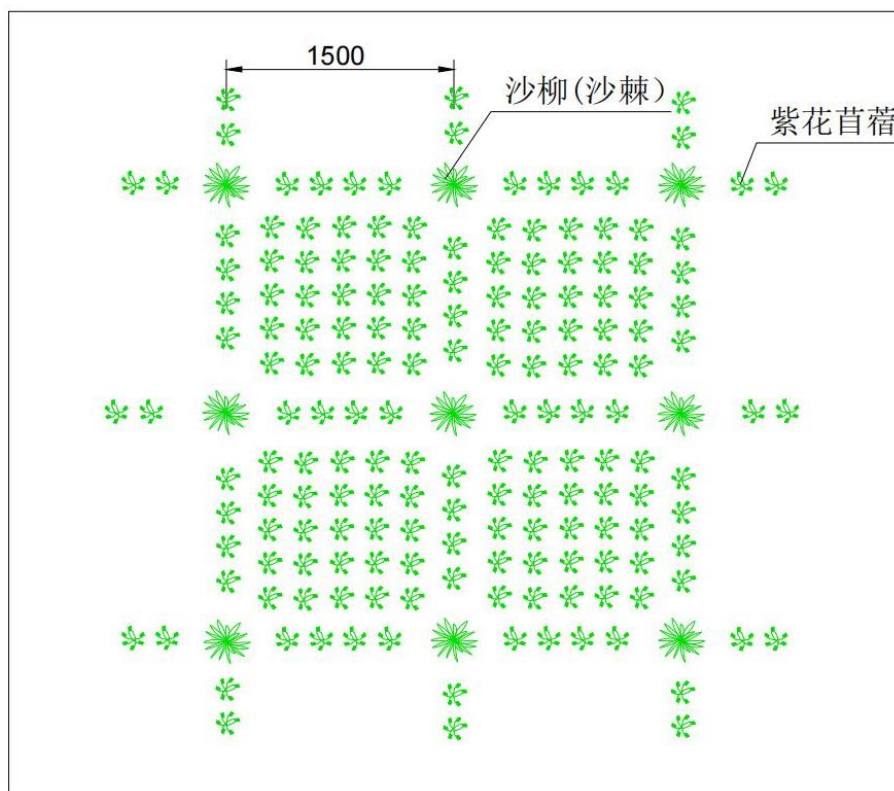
沉陷区灌木（其他）林地栽植平面图
